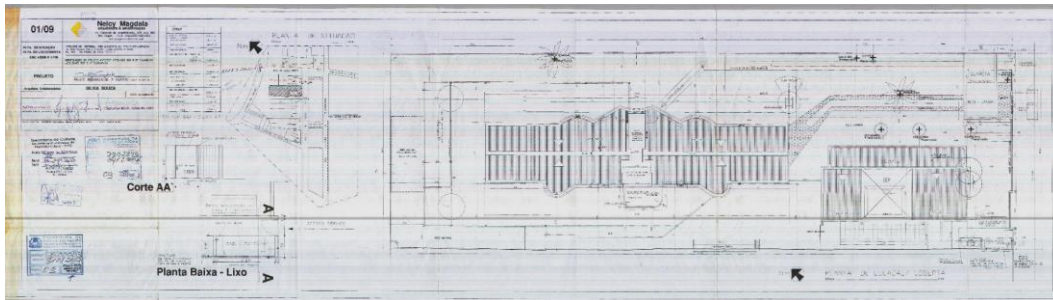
Planta de locação e cobertura do Edifício Praça de Casa Forte. Fonte: Arquivo da Prefeitura de Recife (2006).
